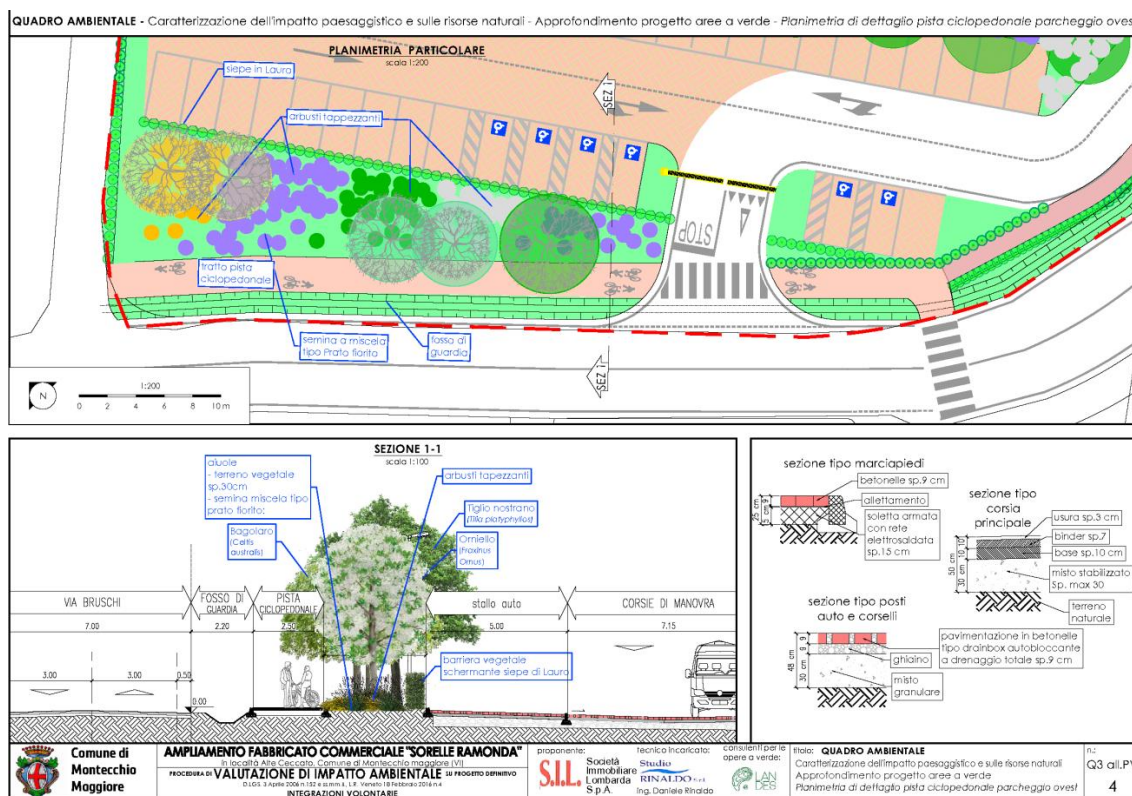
Tavola Q3.all.PV.4 Pianimetria di dettaglio pista ciclopedonale, parcheggio ovest
